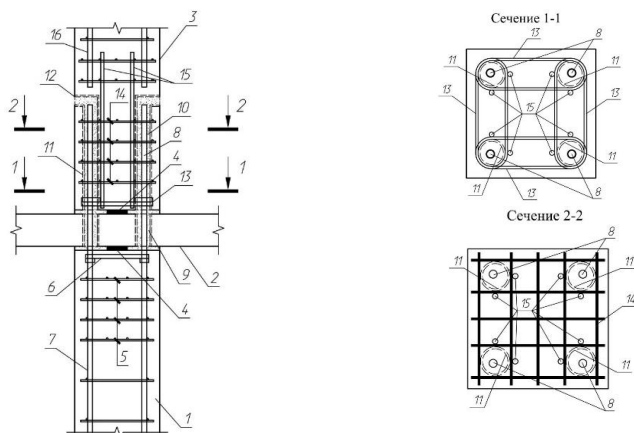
Штепсельный стык колонн с плитой перекрытия по патенту на полезную модель №164018:
